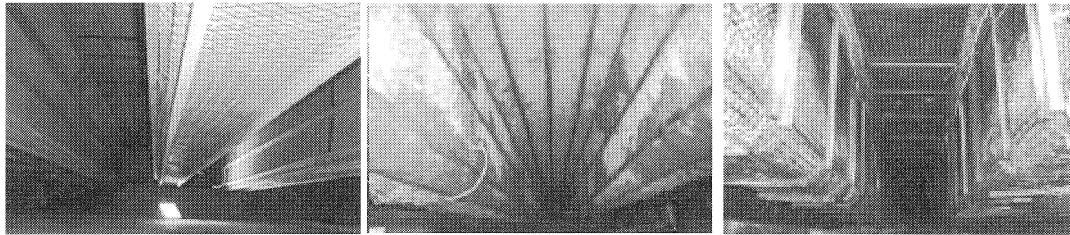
チタンメッシュ取付状況 写真-3 ファイバー吹付後状況 写真-4 プラスチック製ネット固定
